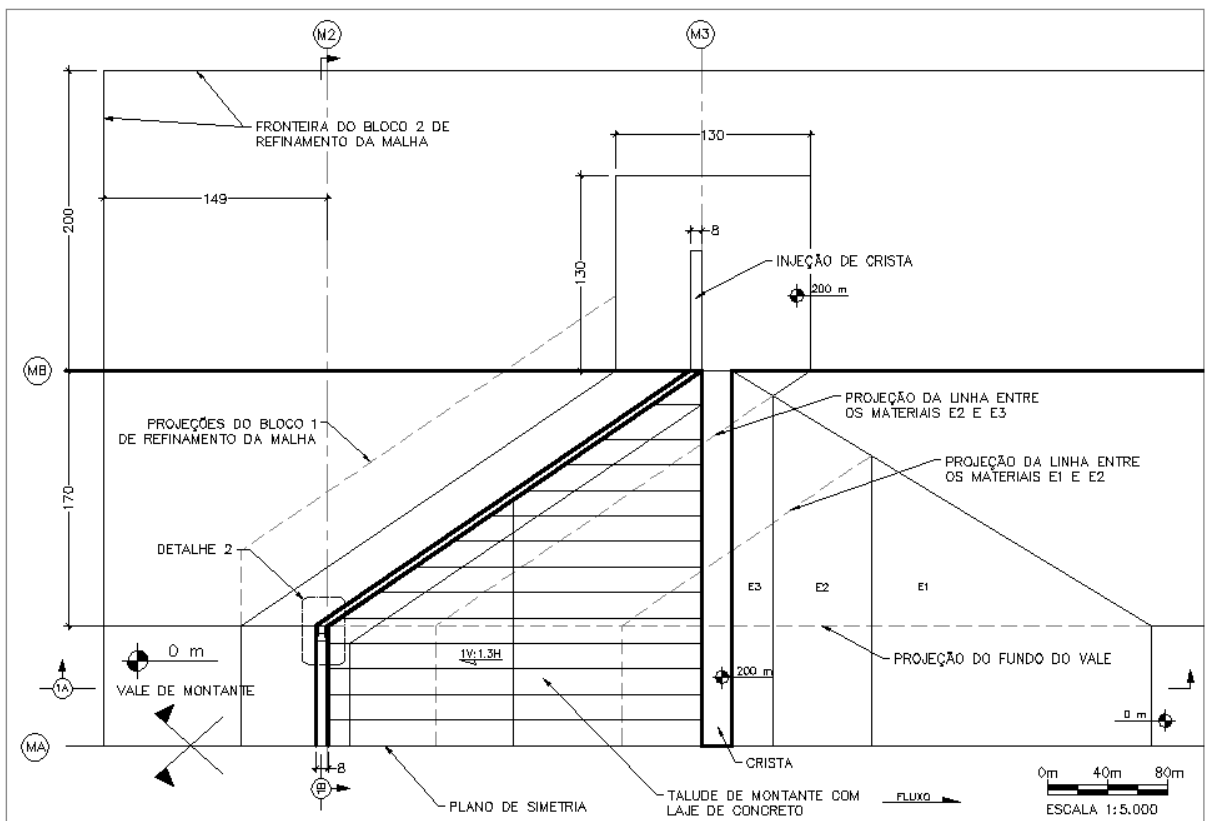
Detalhe 1 da planta com subdivisões para a aplicação dos MEF. Escala 1:5.000.
